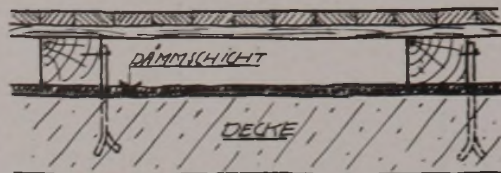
Massivdecke mit Lagerhölzern und schwimmendem Estrich. Wärmetechnisch gut, doch schalltechnisch mangelhaft, weil die Anker der Lagerhölzer den Estrich durchstoßen und die Schwingungen des Trittschalls auf die tragende Decke übertragen, der im unteren Raum stark wahrzunehmen ist.
